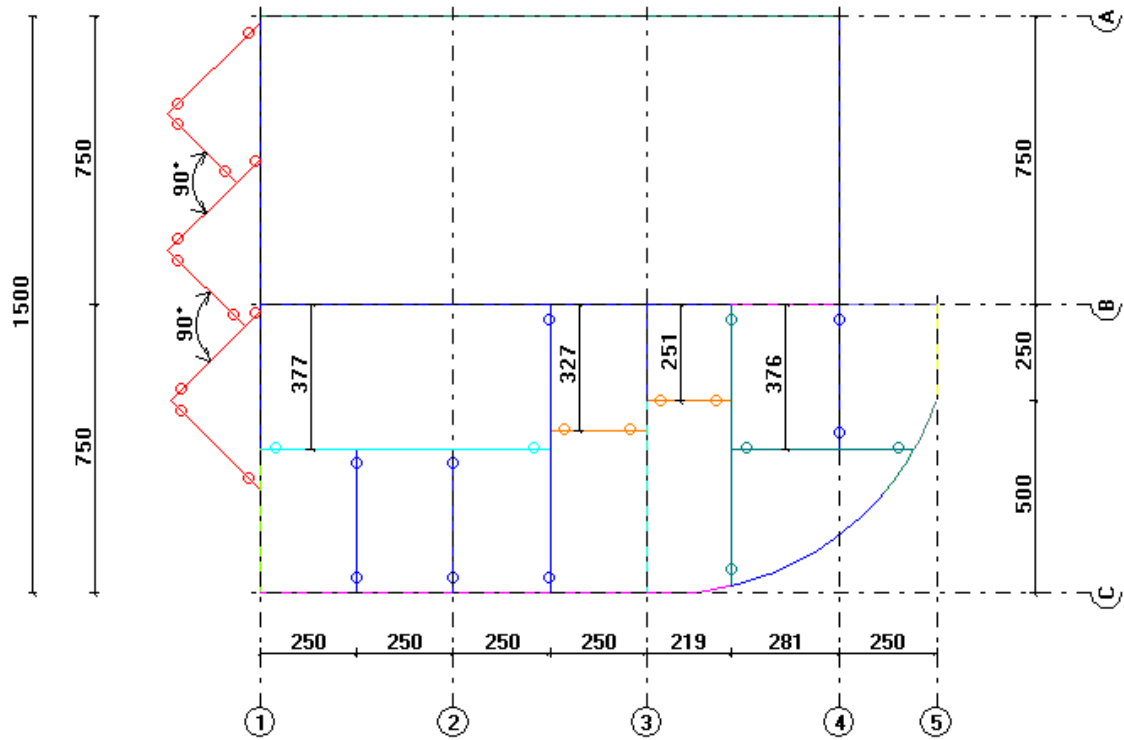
Modelo Estrutural – Planta Mezanino Cotado – Dimensões em cm
